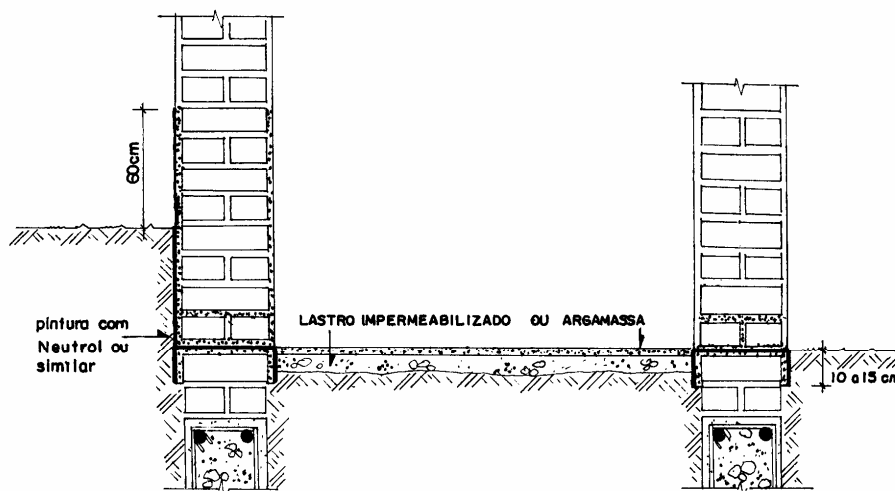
Detalhe da aplicação da argamassa impermeável
